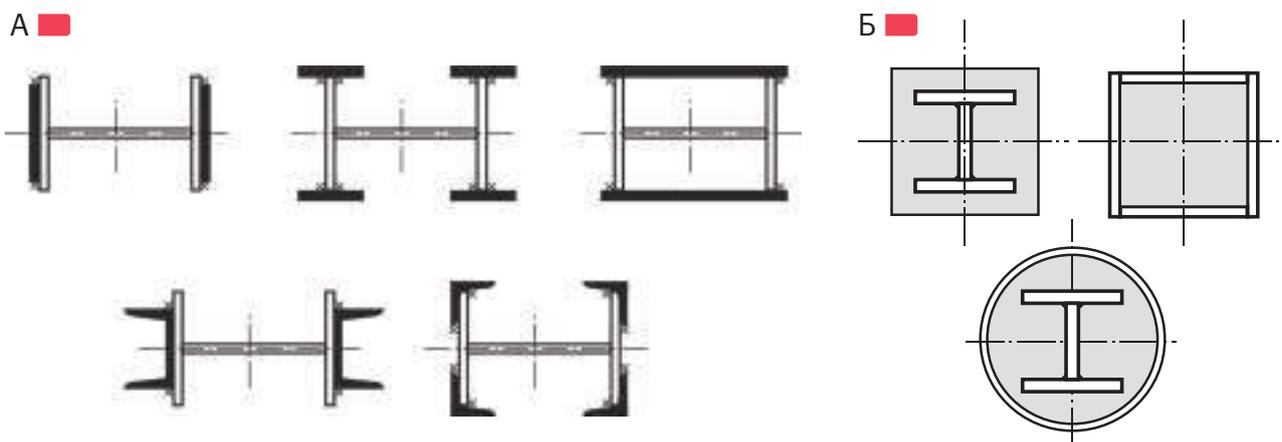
Усиление металлических двутавровых колонн путем увеличения сечения: А – приваривание стальных элементов; Б – обетонирование и заполнение бетоном
